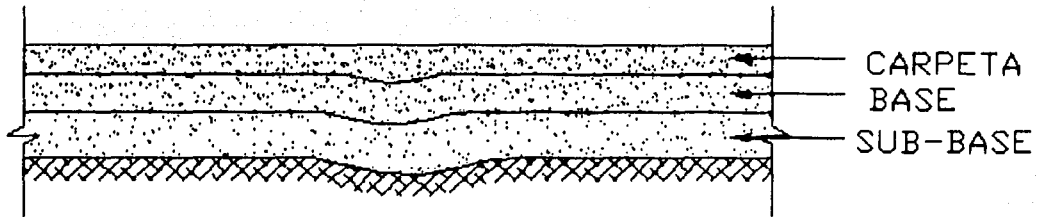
Flexibilidad del pavimento para adaptarse a las fallas
